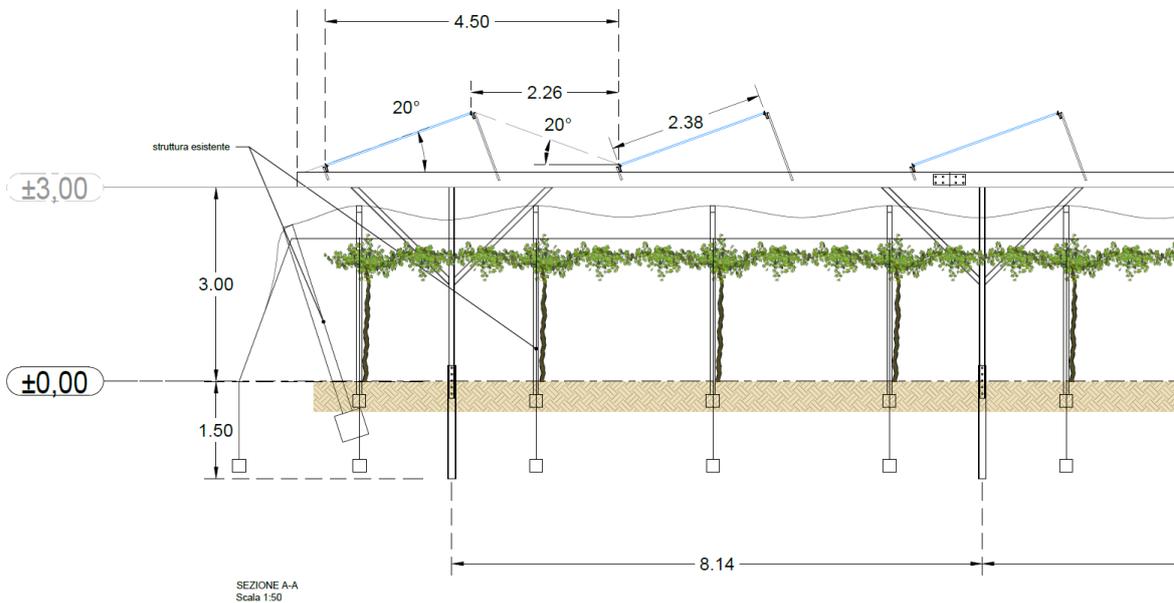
Particolare costruttivo sezione trasversale tipologica strutture fisse di supporto con le dimensioni fuori scala. Localizzazione Lotto A, sottocampo 12*.
